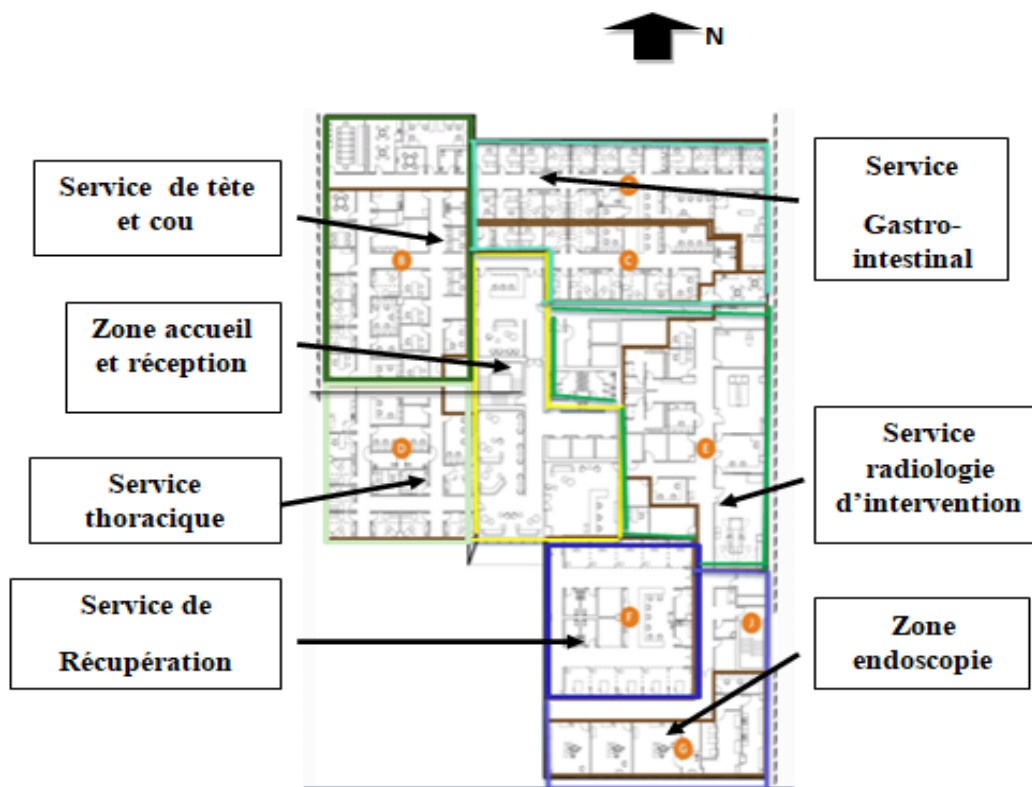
Plan 3^{ère} étage (www.archdialy.com)
